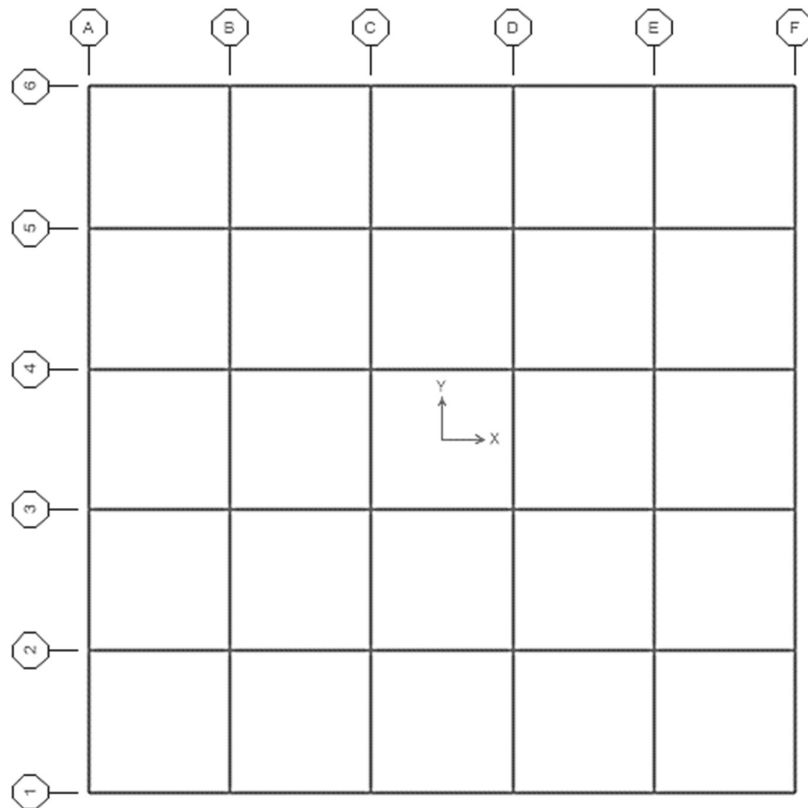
Vista en planta de los pórticos / vista de la estructura en SAP 2000.
